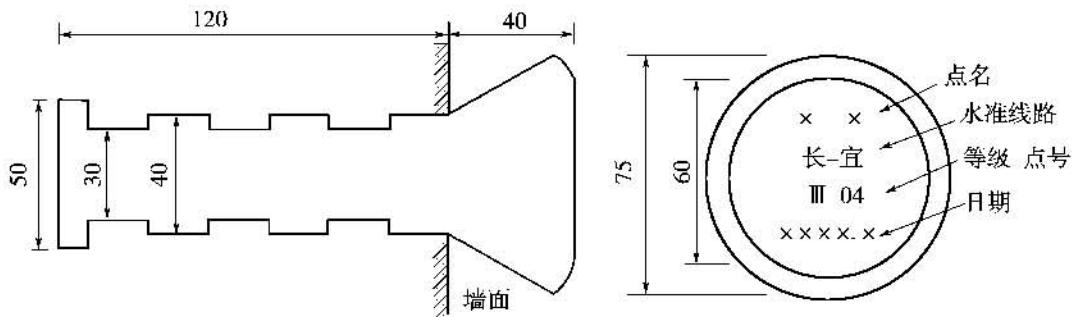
墙脚标志埋设示意图(单位:mm)
